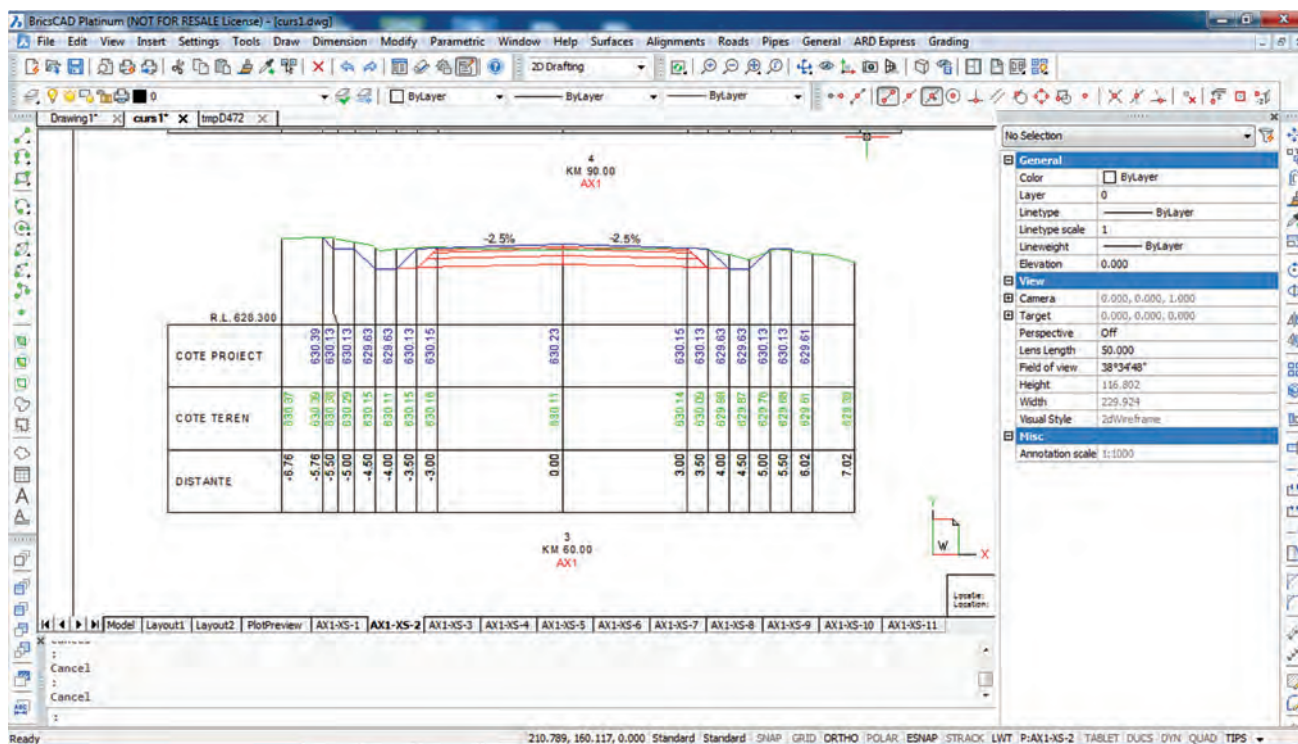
Aplicarea profilului transversal tip pe structură clasică în picheți prestabiliți
